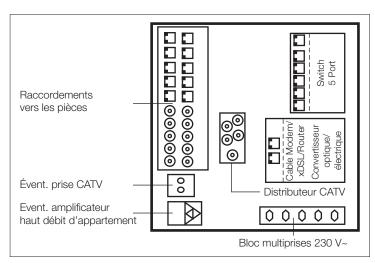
détail du distributeur pour un appartement de 3½ à 4½ pièces
